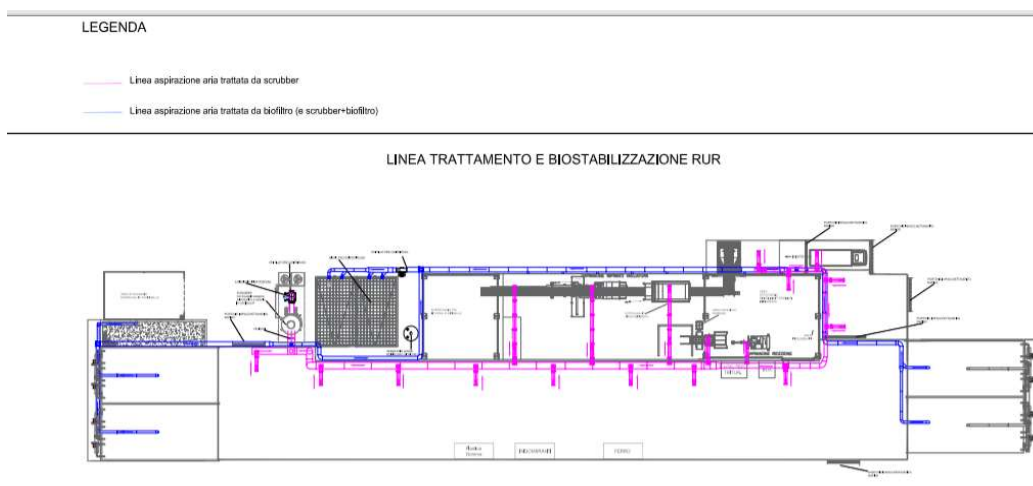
stralcio della TAV. 11 - Planimetria di progetto - Rete impiantistica trattamento arie
